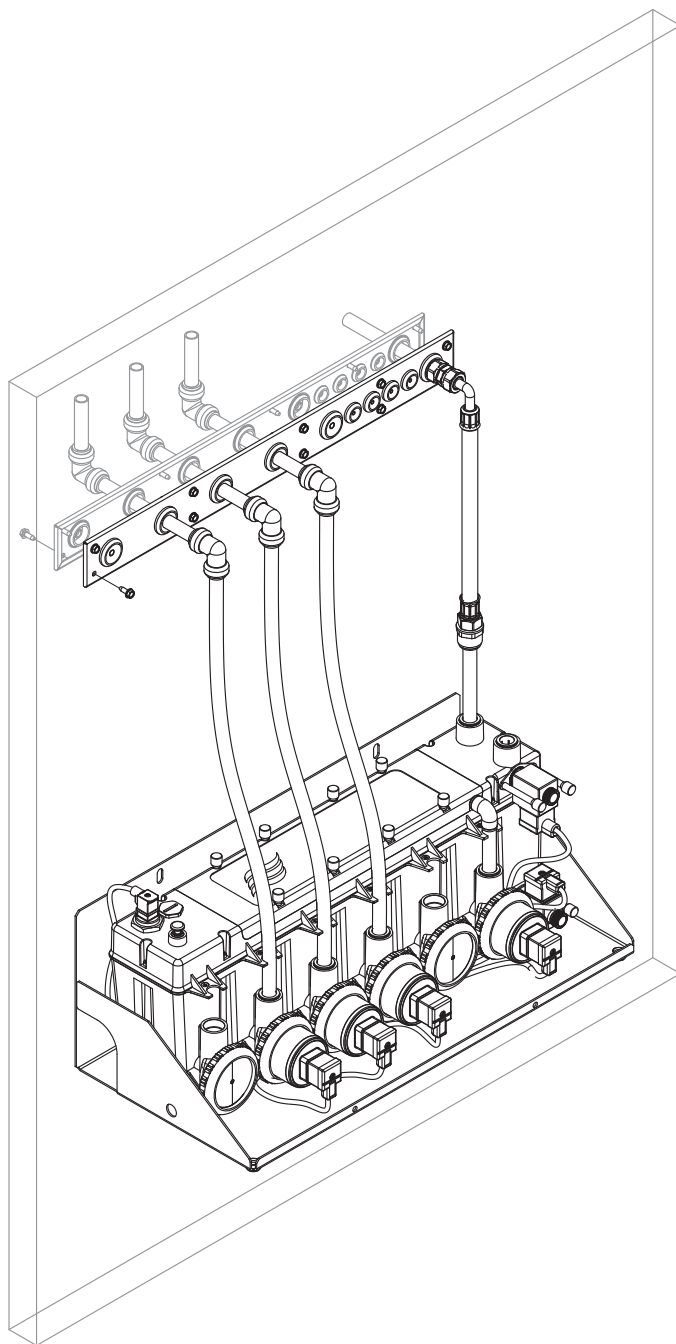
Fissaggio della piastra passaparete alla parete del condotto (installazione esterna)
